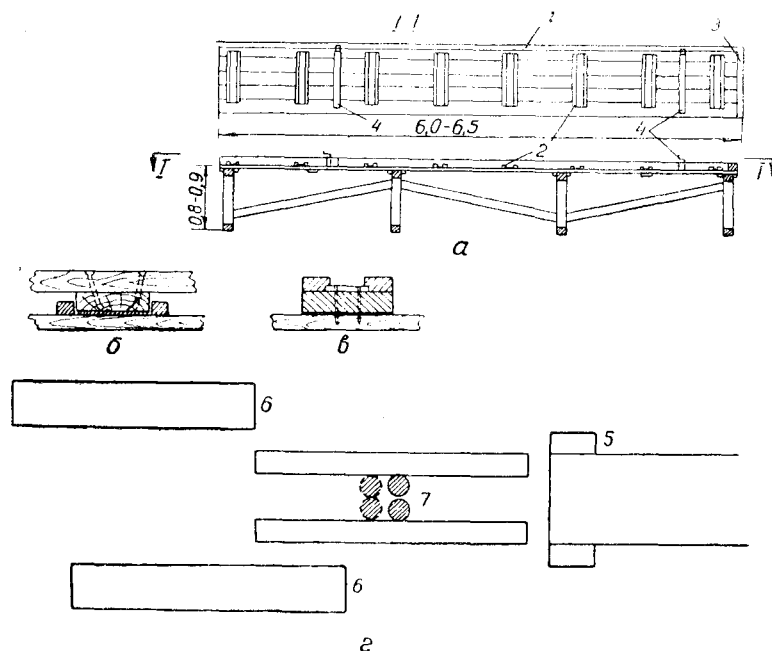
Верстак-шаблон для изготовления щитов опалубки:
